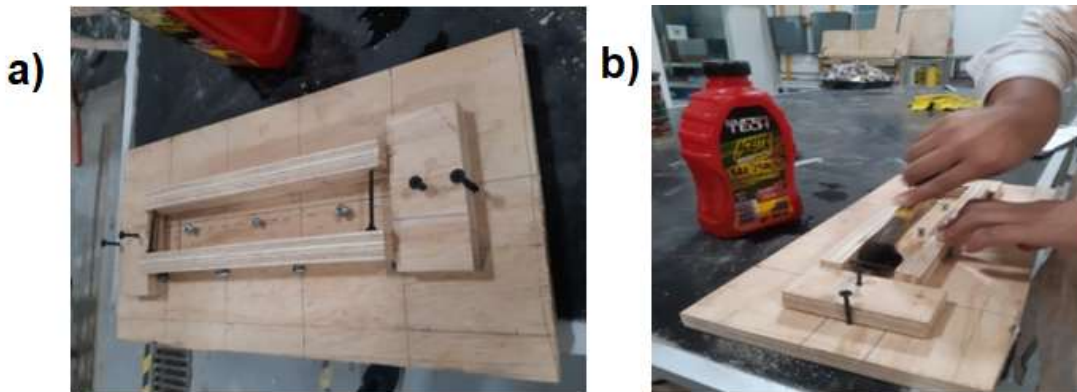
a) Molde con cimbra, b) Colocación de aceite en la cimbra.
